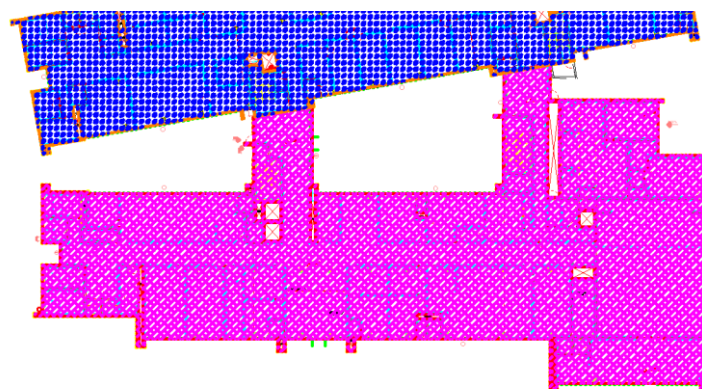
Áreas consideradas para o pavimento em contato com a fundação (Térreo)
